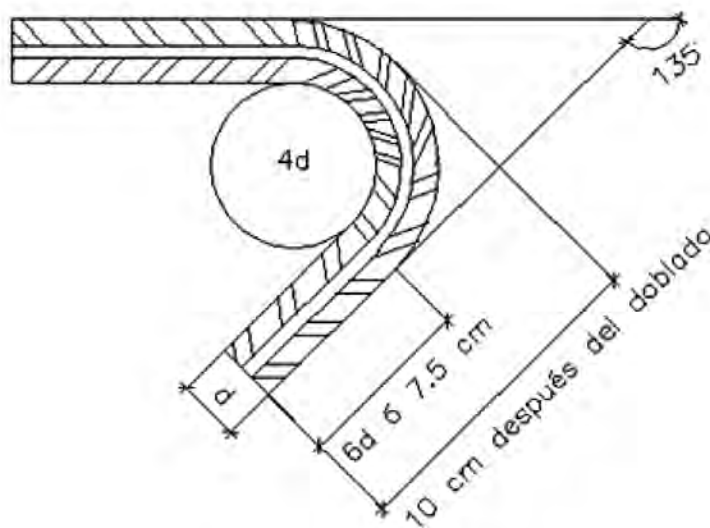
Geometría del gancho longitud de doblado de estribos de 8 mm
